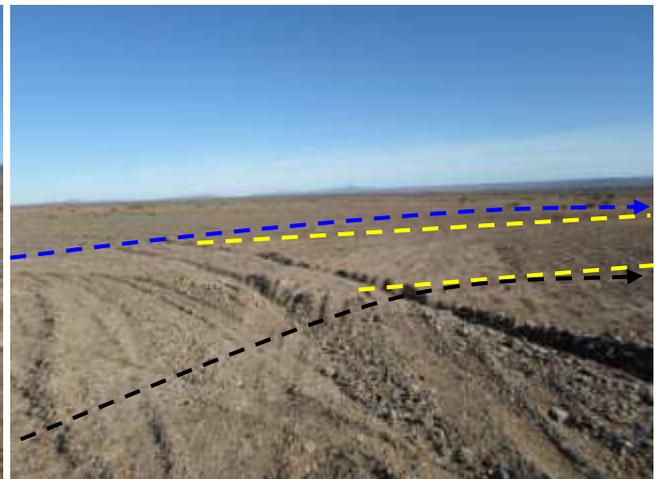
Emplazamiento de línea general y línea de control por margen interno de futuro camino de acceso y luego por futura locación. Foto en dirección O.
